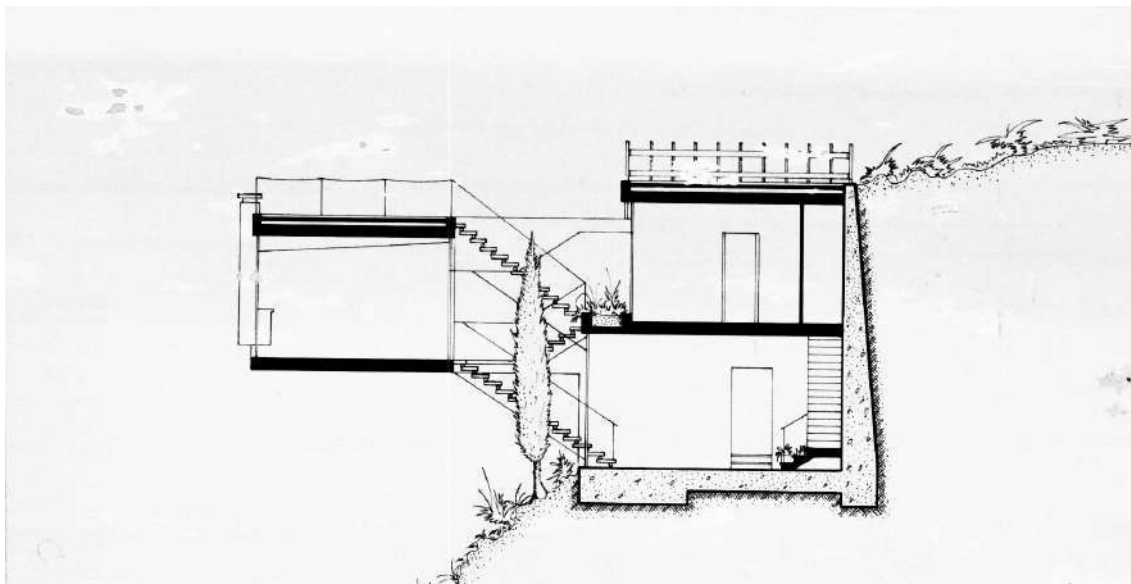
Sección del proyecto construido. Fundación Bosch Aymerich.
